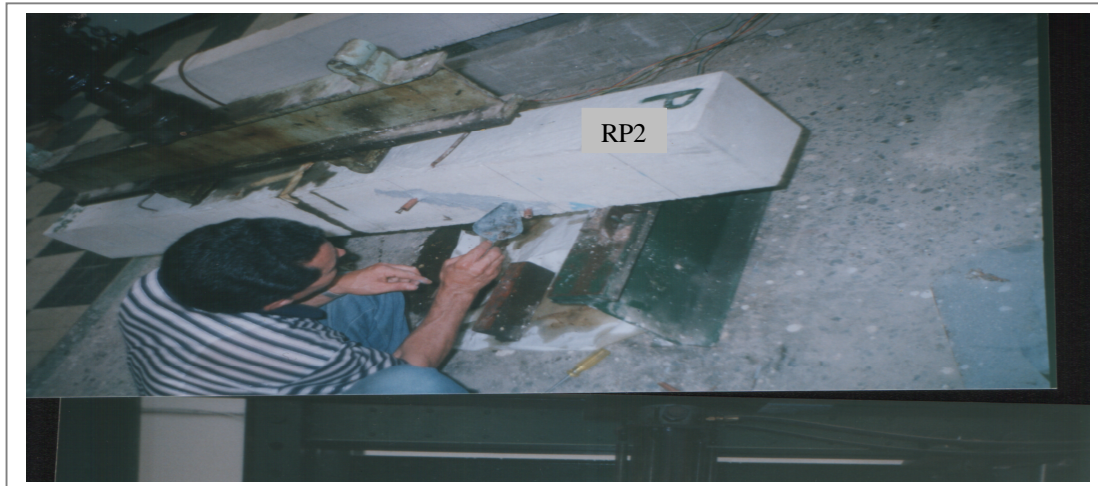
Colmatage et calfeutrement des fissures de la poutre endommagée
